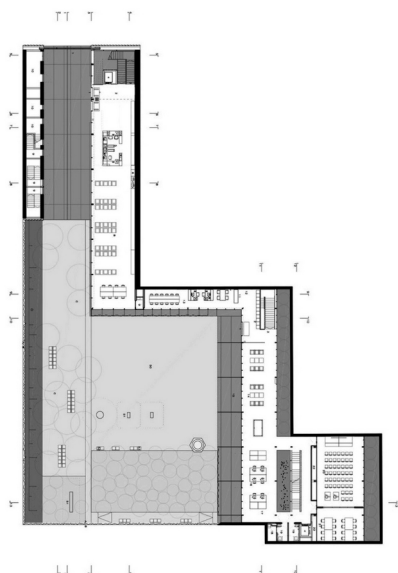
Plan przyziemia. Elewacja frontowa nowoprojektowanej części kompleksu.
